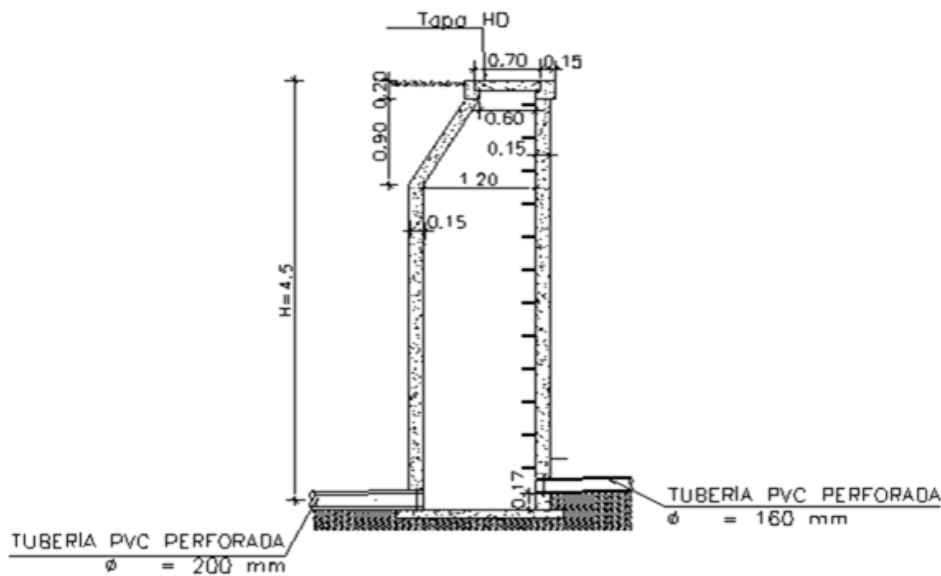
Pozo de Subdrenaje Llano Grande Alto, vista en corte
